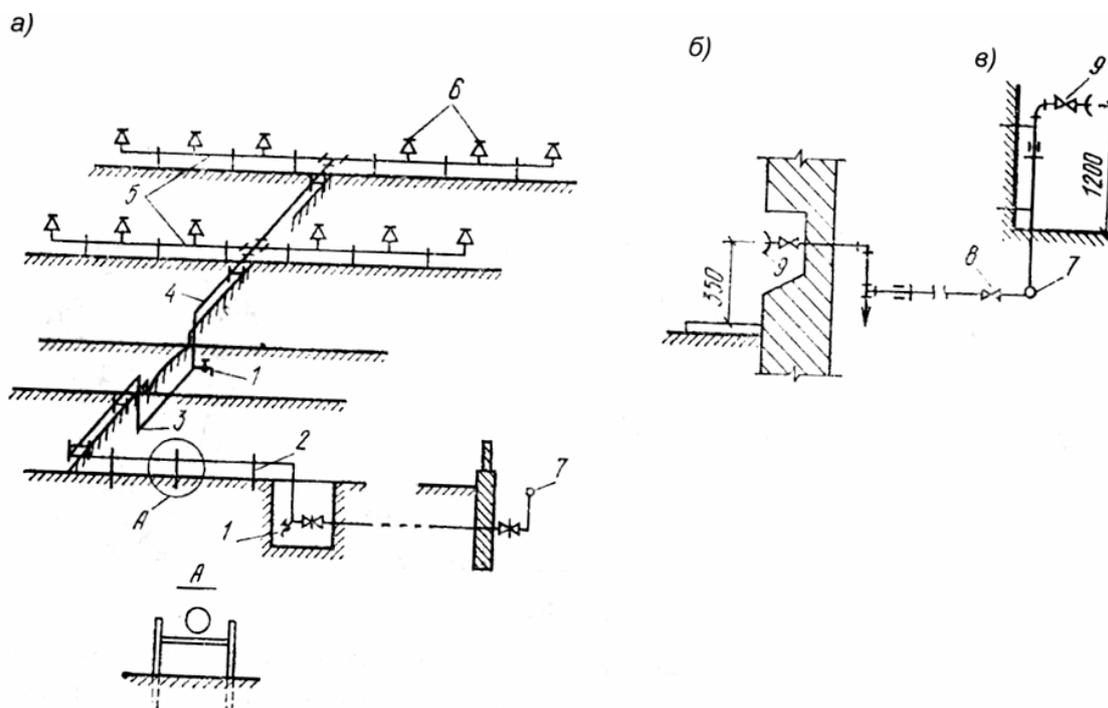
Схема поливочного водопровода: а – схема поливочного летнего водопровода; б – поливочный кран у здания; в – установка поливочного крана в помещении; 1 – спускной кран; 2 – опоры; 3 – пересечение дороги; 4 – магистраль; 5 – распределительная сеть; 6 – оросители (поливочные краны); 7 – магистраль внутреннего водопровода; 8 – вентиль; 9 – поливочный кран с быстросмыкающейся полугайкой
